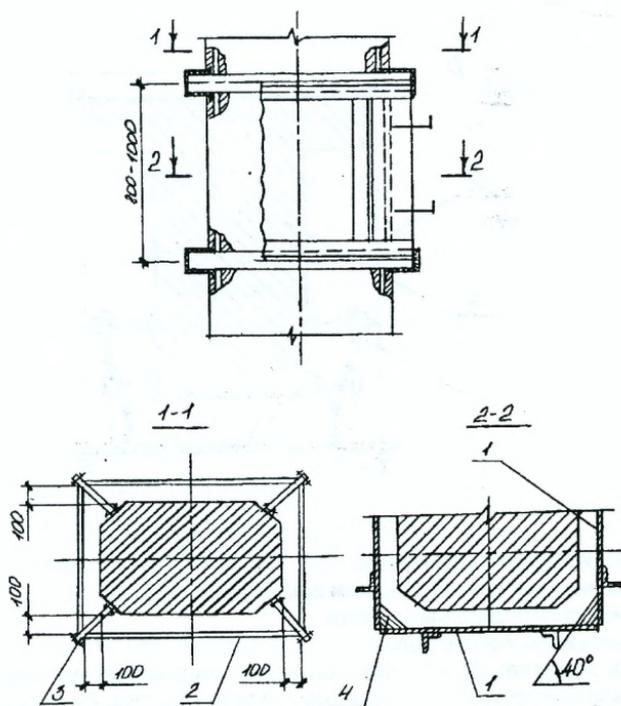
Крепление щитов опалубки к «воротникам»:
